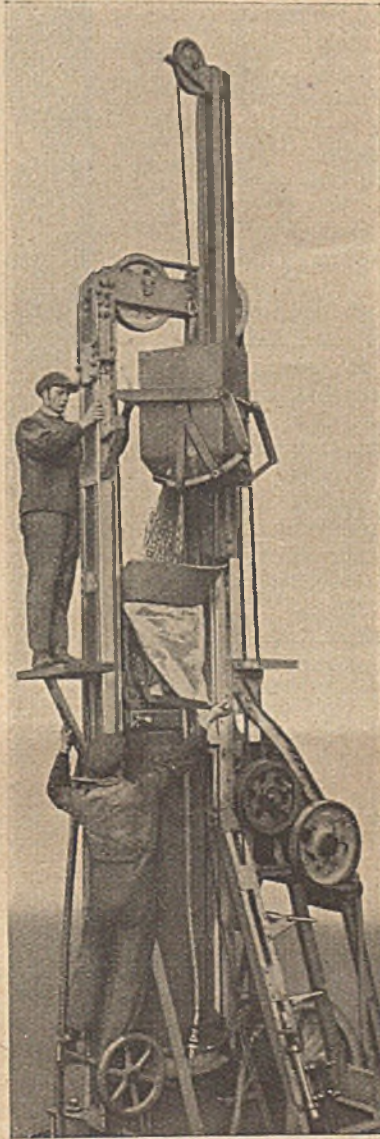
Zentraler Betonvortrieb durch die Grundkörpermaschine.
